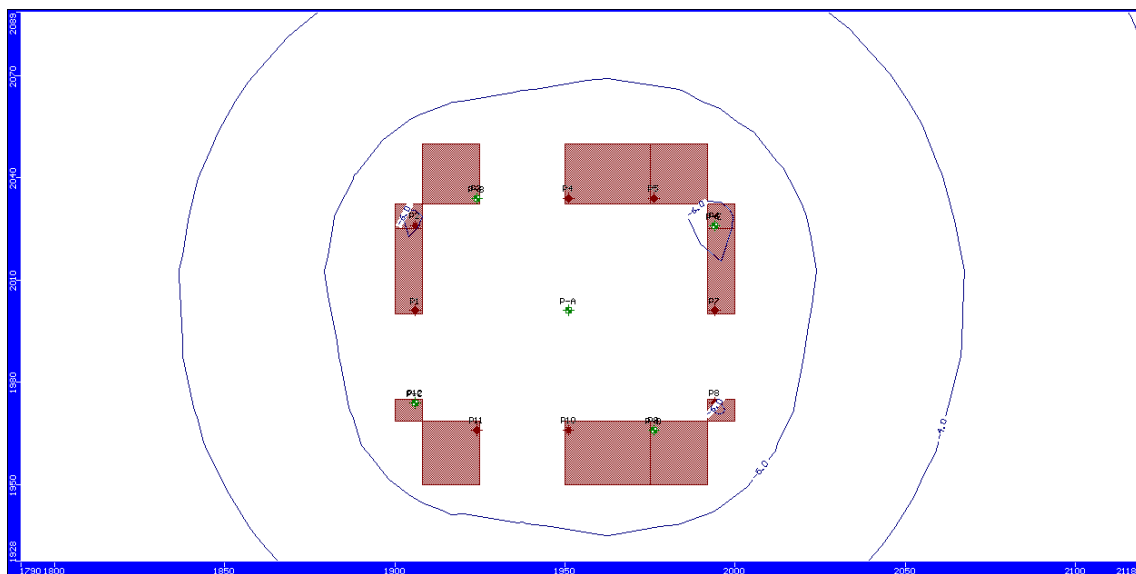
Vista en planta de la zona de excavación (capa arenas)
